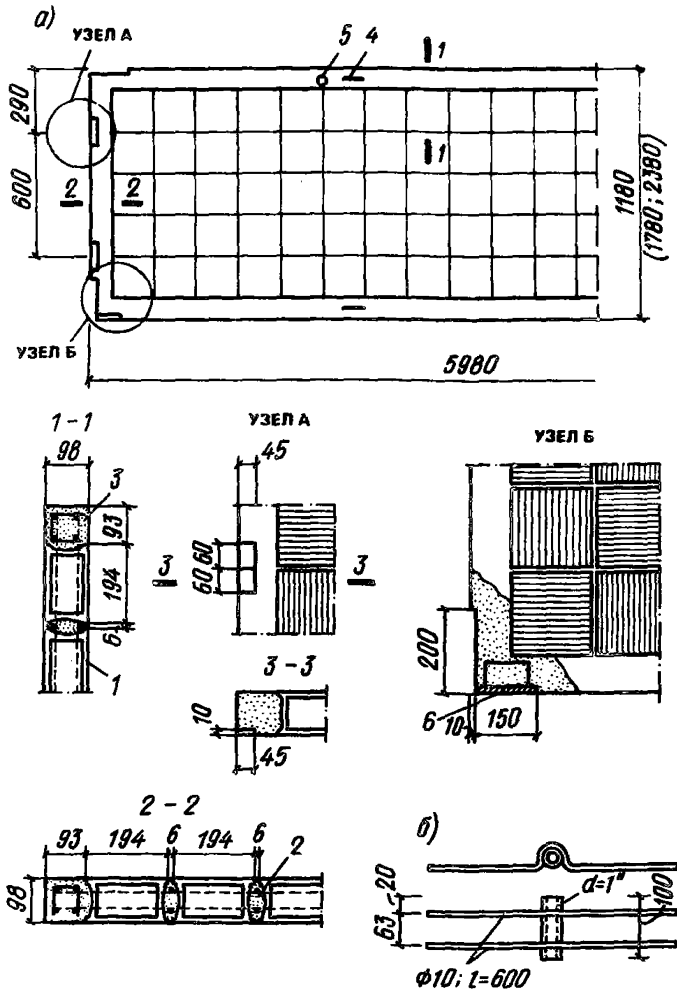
Вертикальная стекложелезобетонная навесная панель толщиной 98 мм (плоская) из стеклоблоков БК 194/98
